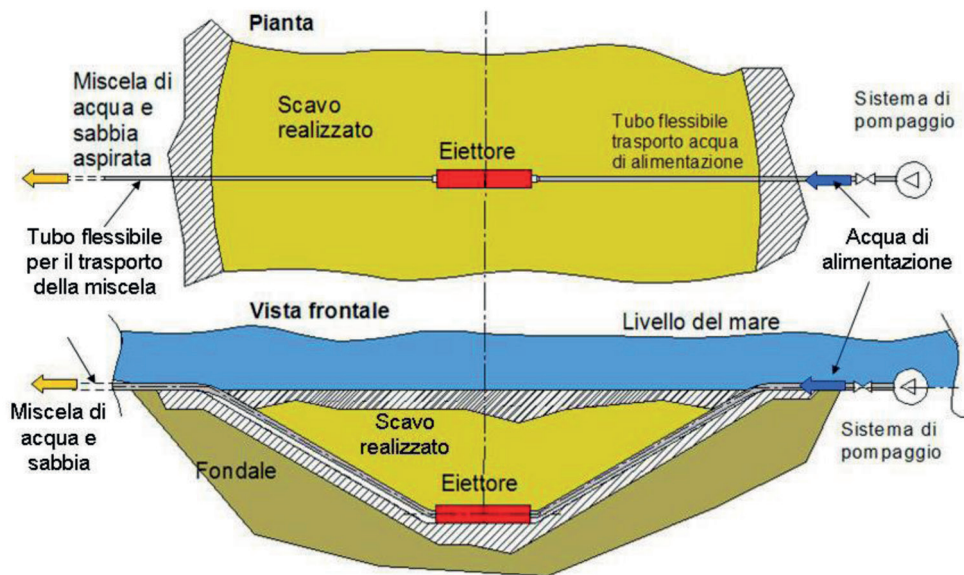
Visione in pianta ed in sezione di un eiettore.
